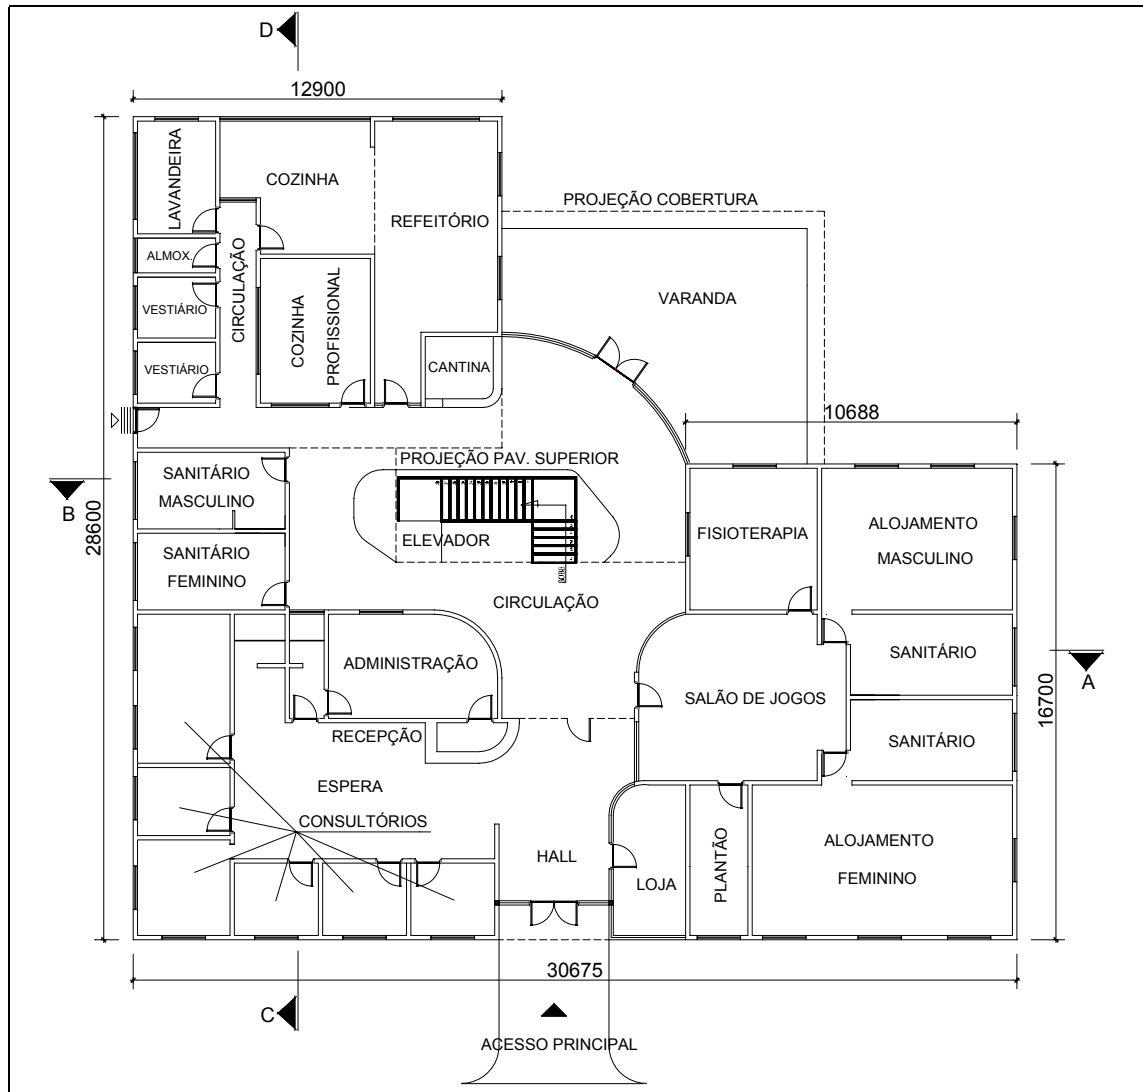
Planta baixa do primeiro pavimento do Edifício 3.
